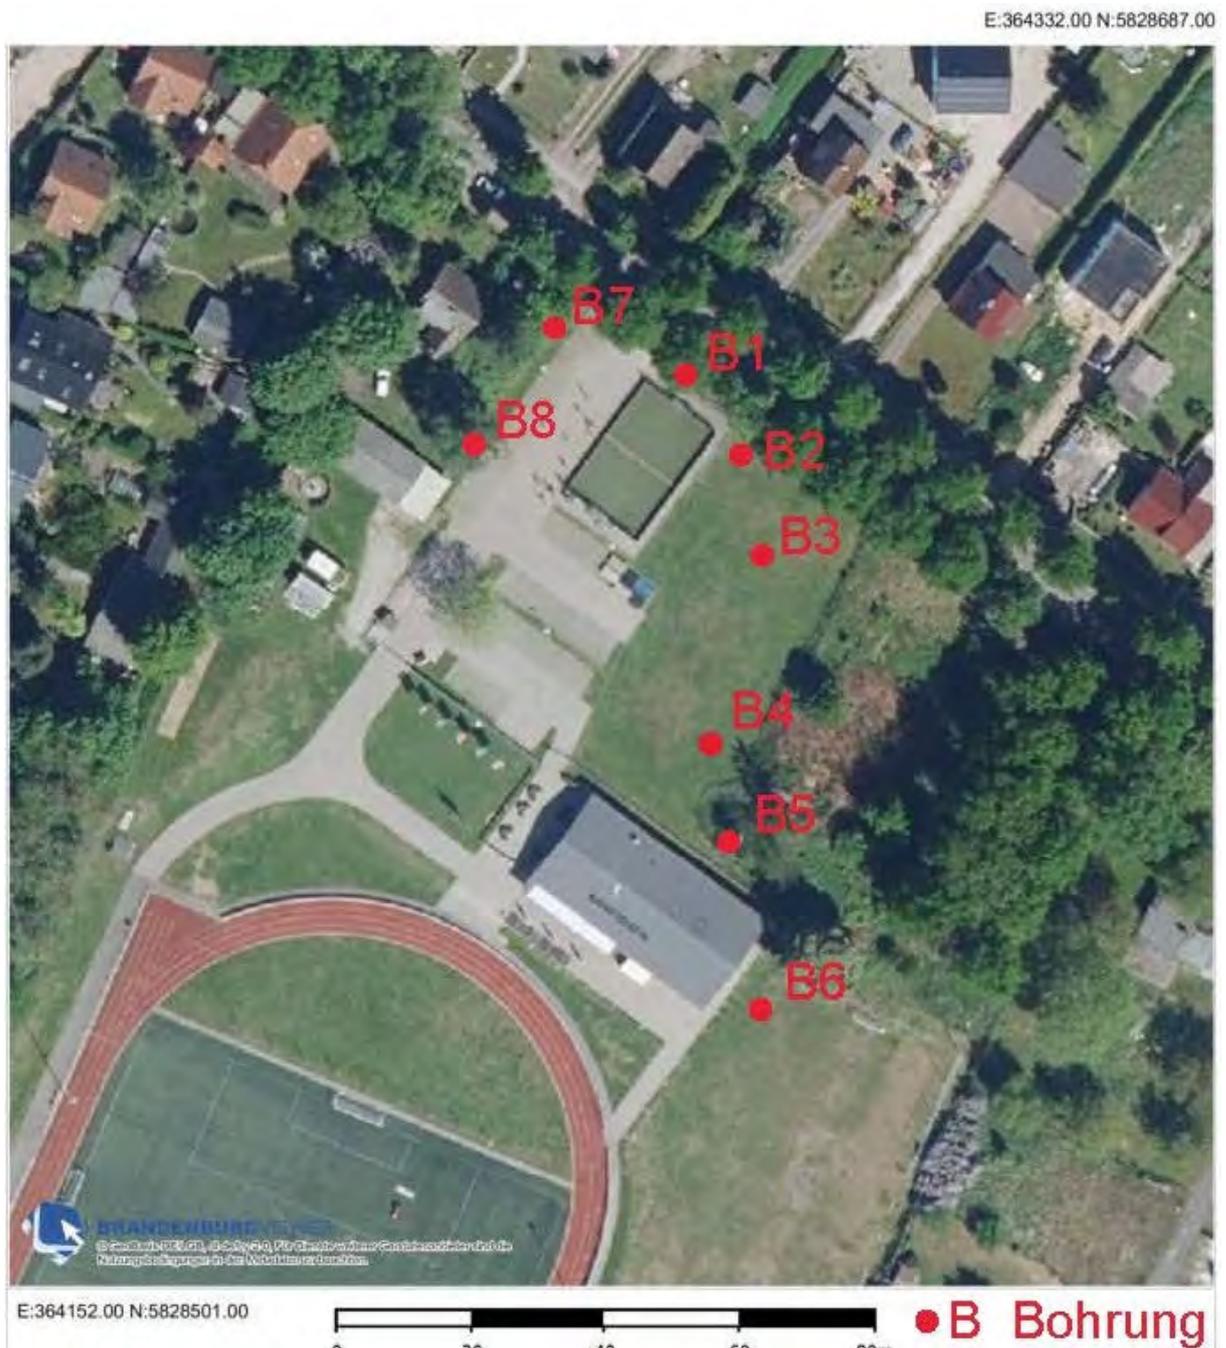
baulab Prüflabor für Erd- und Grundbau Baugrunderkunden & Umweltgeologie
